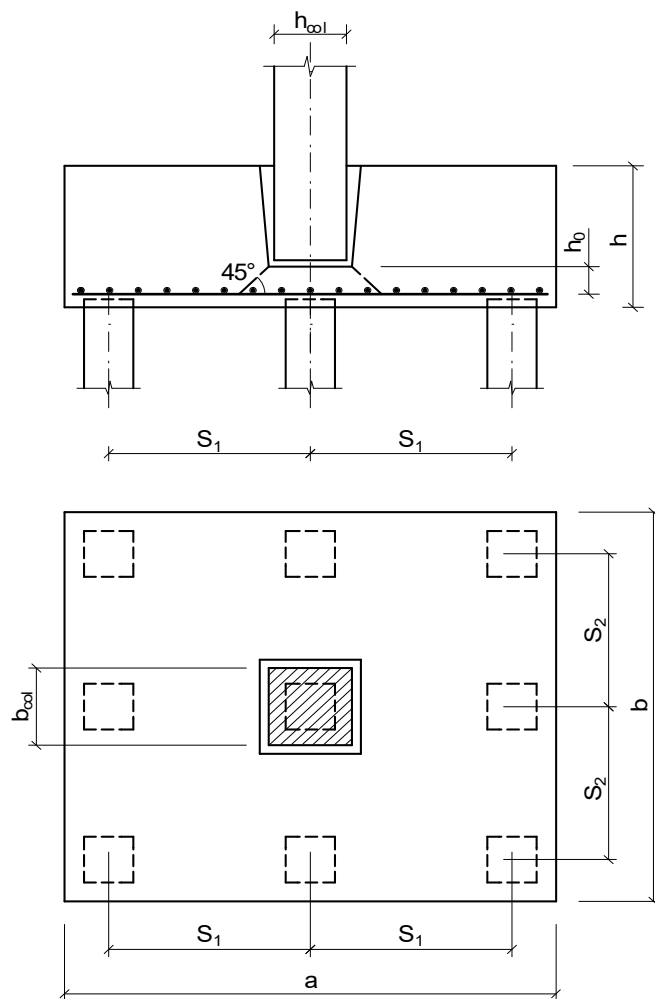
Схема пального фундаменту з плитним ростверком
